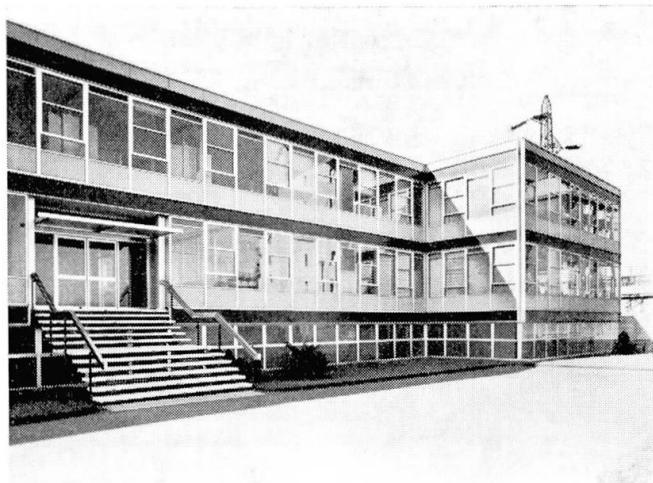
Geschäftshaus Boston Nastri, Bollata, Mailand. Unverkleidete Stahlkonstruktion.
